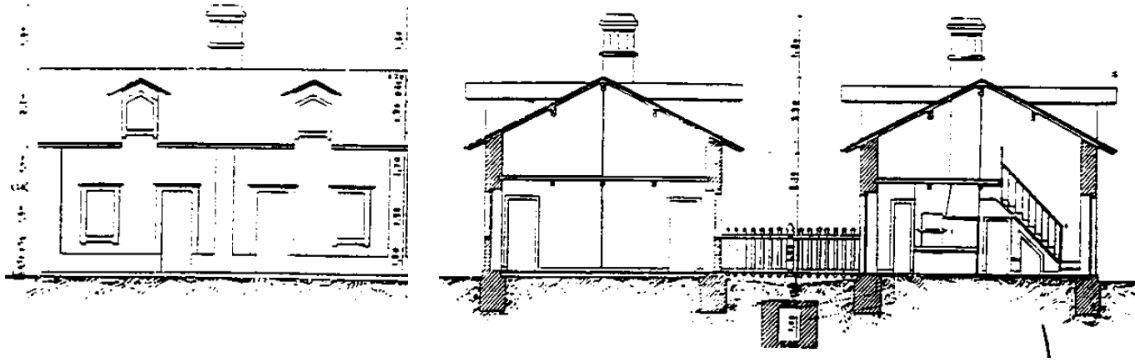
Alzado y secciones de las casas del Campo de Artillería (FUENTE: PXOM 1998).
